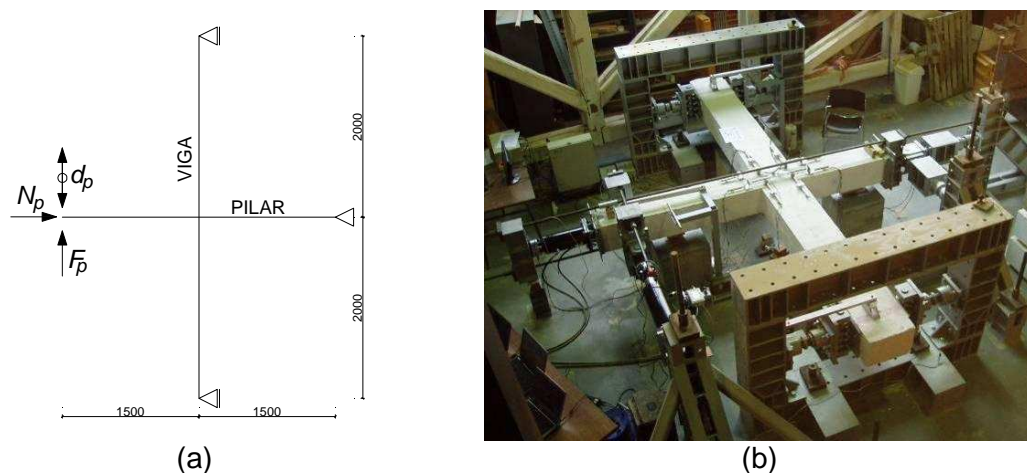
Configuração de ensaio dos nós interiores: (a) Esquema estrutural; (b) Foto de um ensaio.
